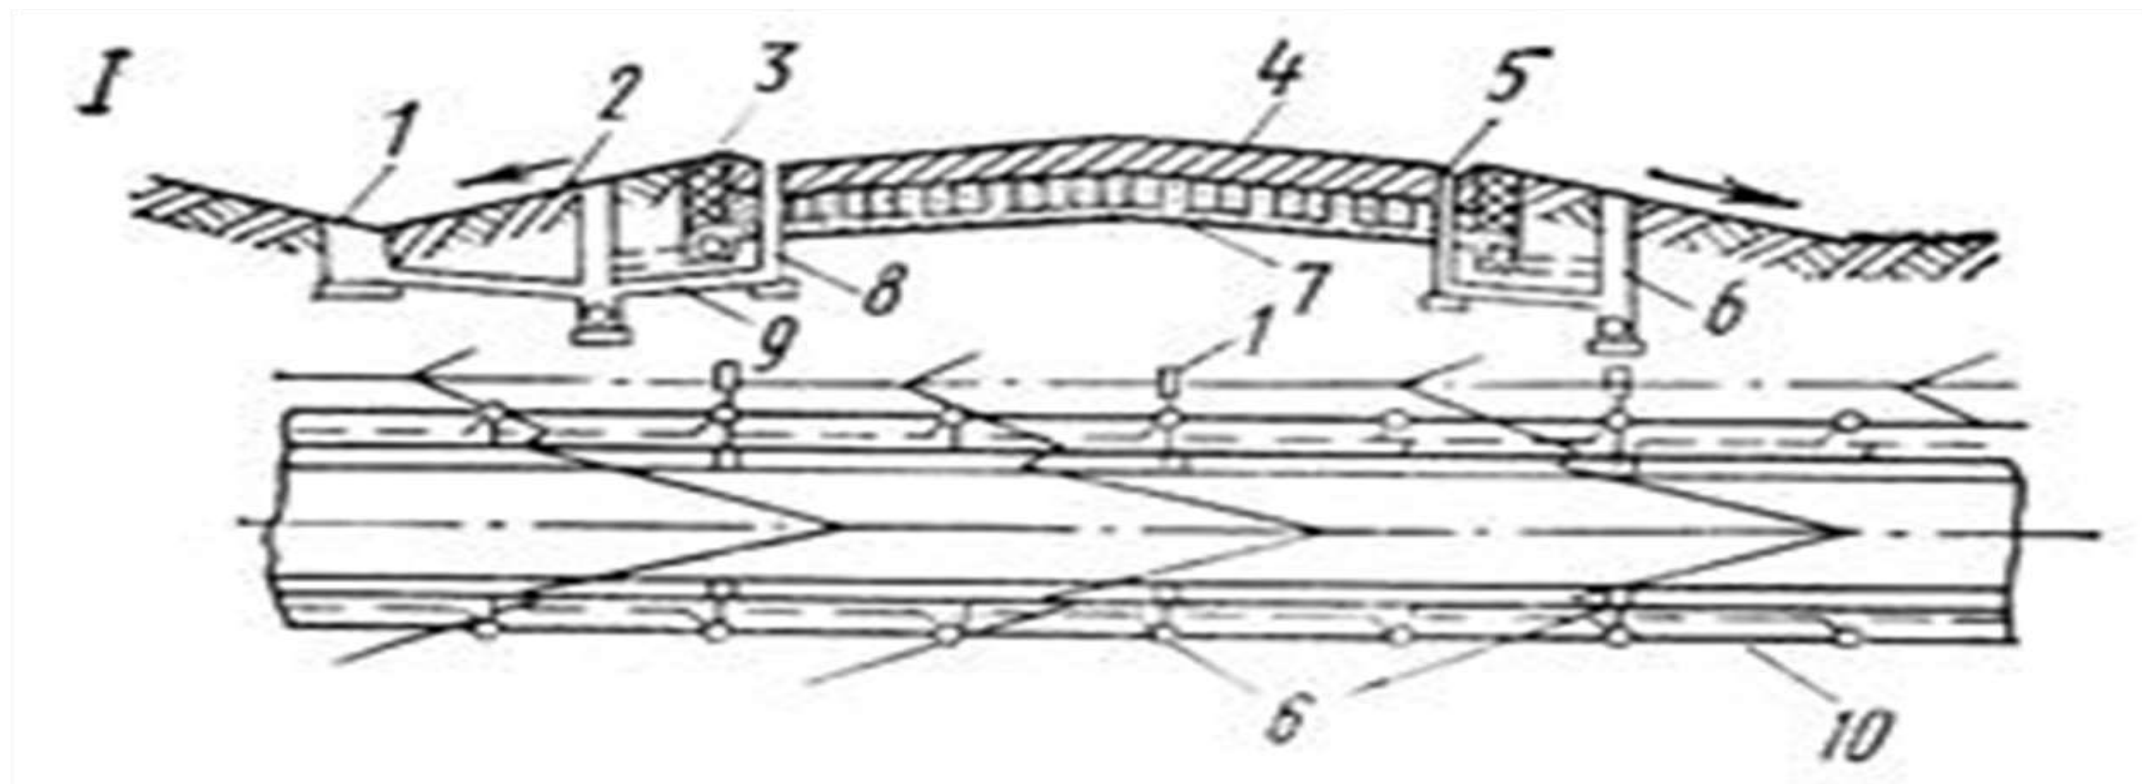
Схема водоотводных и дренажных систем (профиль и план) аэродромных покрытий: 1 – тальвежный колодец; 2 – грунтовой лоток; 3 – отмокстка; 4 – покрытие; 5 – лоток в кромке покрытия; 6 – смотровой колодец; 7 – основание с дренирующим слоем; 8 – дождеприемный колодец; 9 – перепуск; 10 – коллектор;
